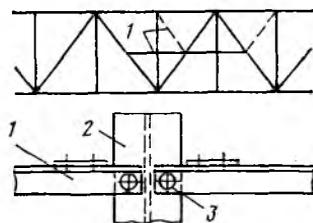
Усиление сжатой подвески уменьшением свободной длины:
